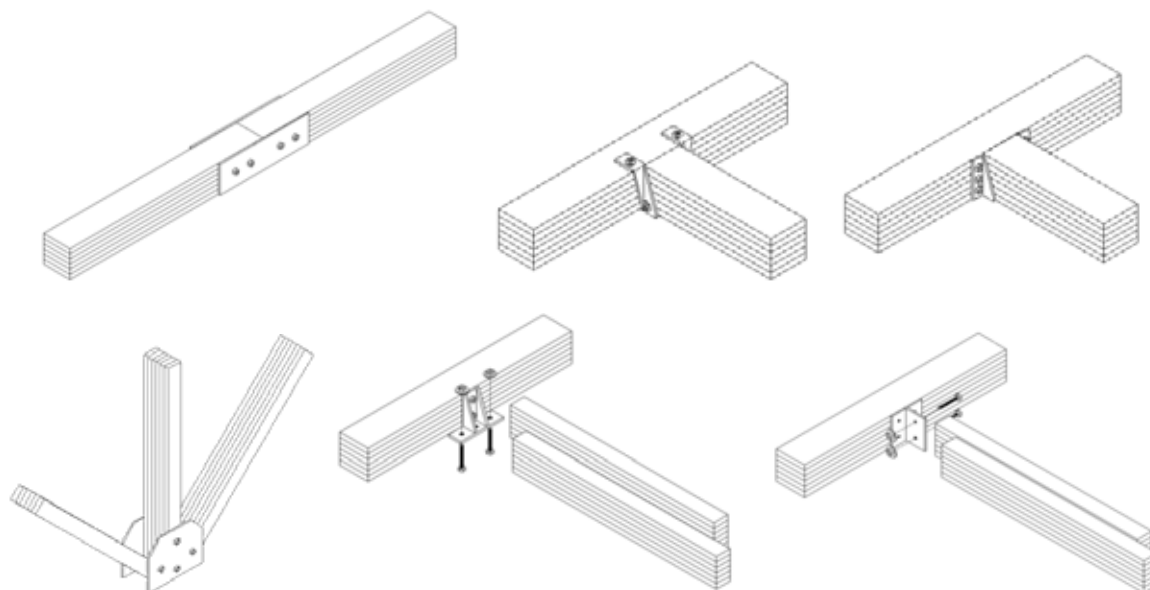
Detalhes das ligações com conectores metálicos mais comuns para os elementos de BLC.
